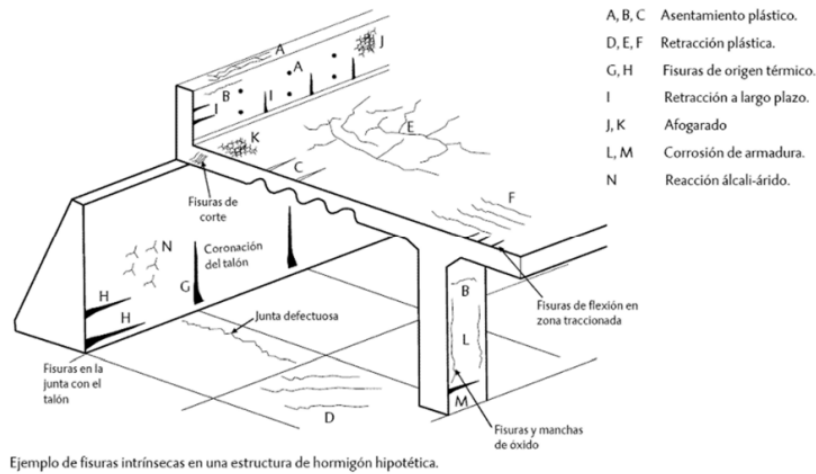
Ejemplo de fisuras en una estructura de hormigón hipotética [24]
